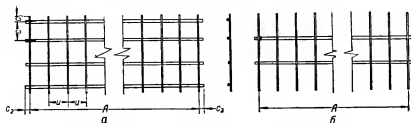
96. Плоские сварные каркасы для колонн:
